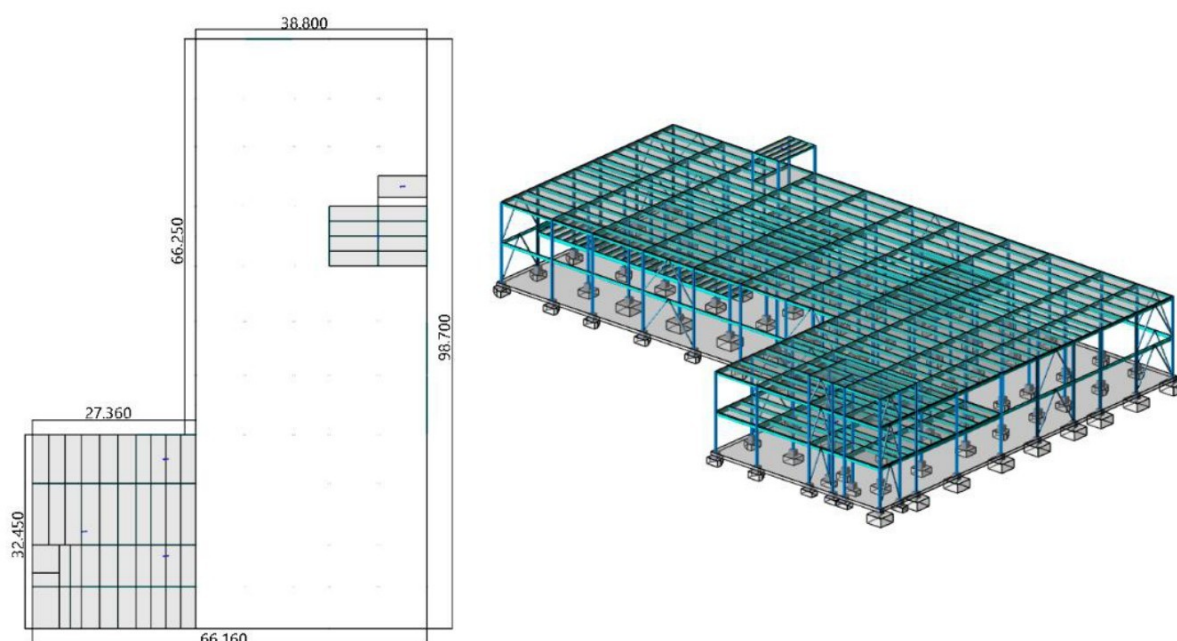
Links, afmetingen van 1^e verdieping in plattegrond (↑ noord) en rechts het constructief model van het ASRS en Warehouse gebouw
